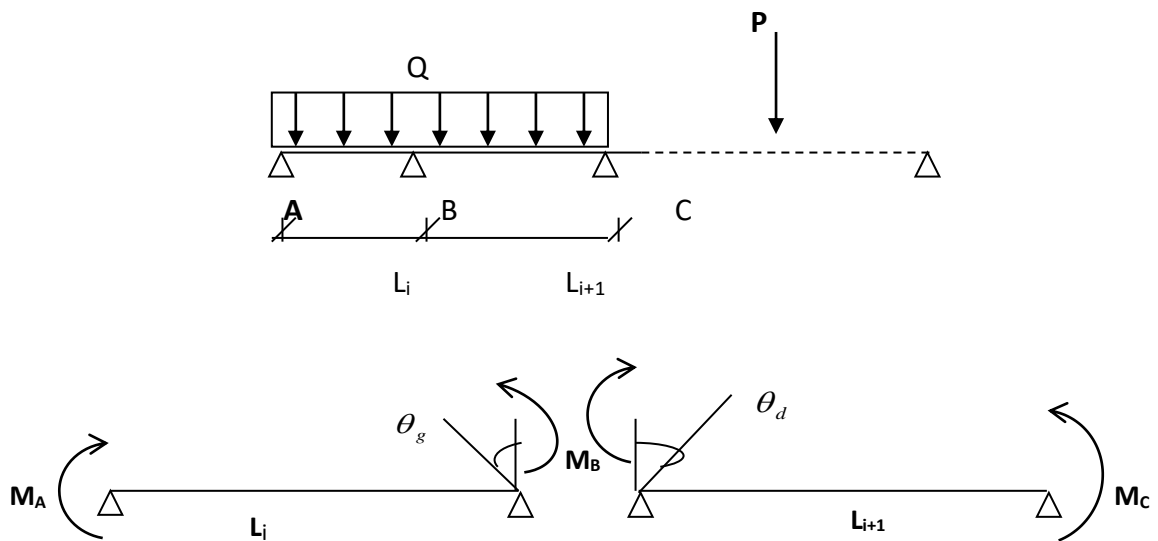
Schéma des poutrelles d'étage inaccessible de bloc A.
